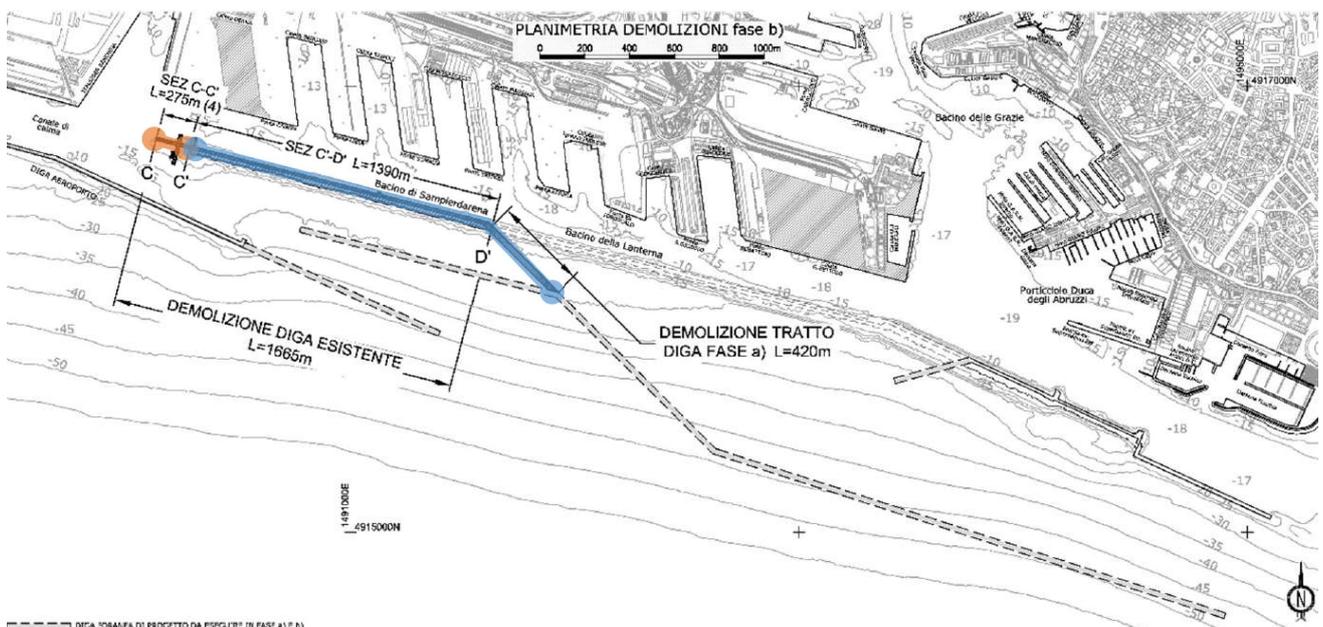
Planimetria con individuazione del tratto di diga da rimuovere – Fase B
